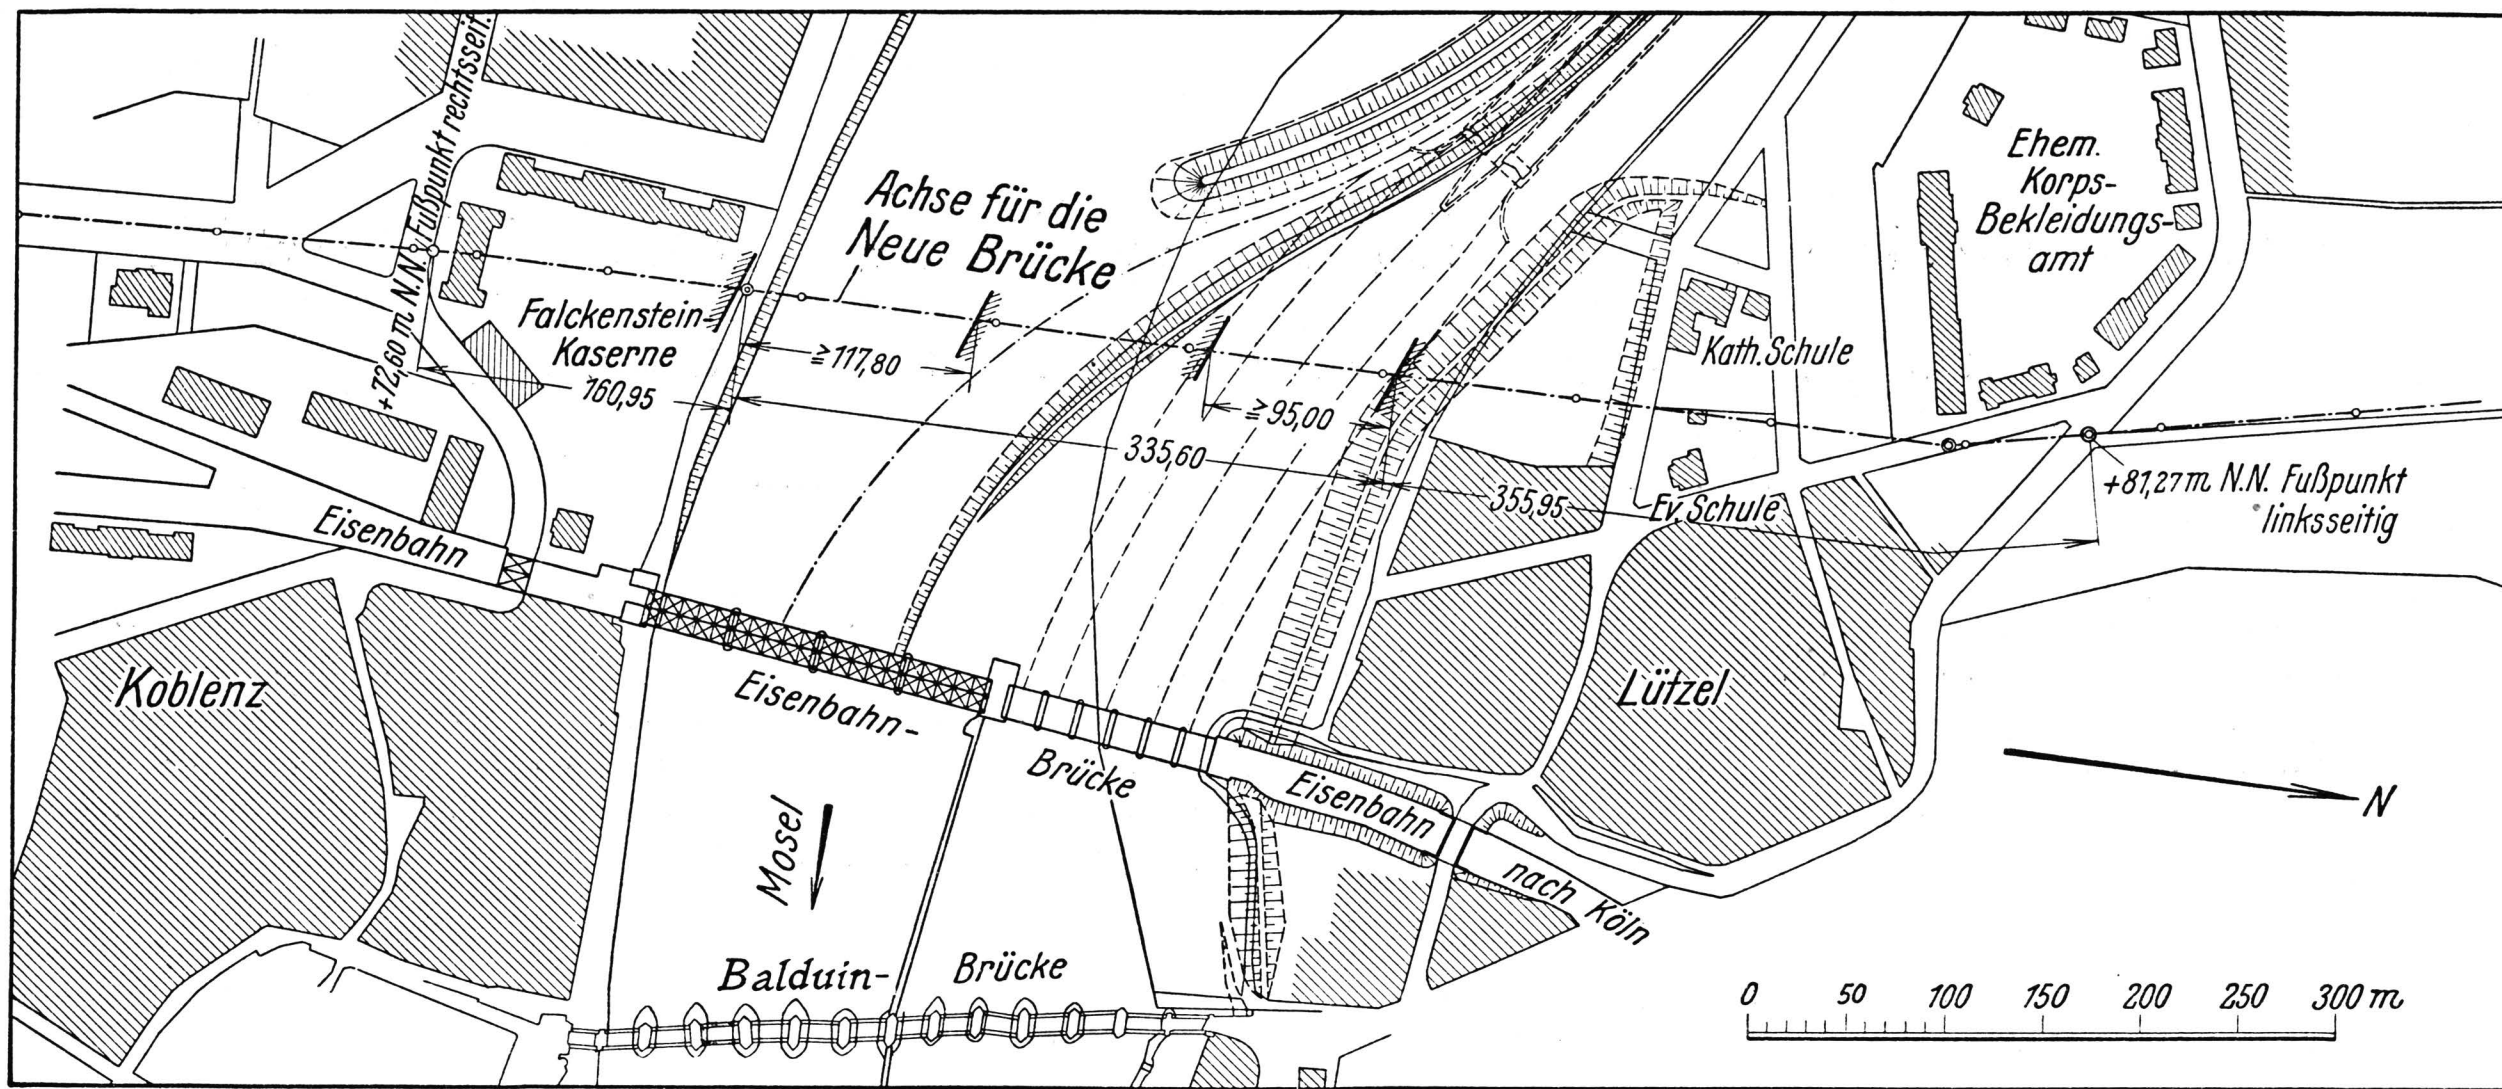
Lageplan der Adolf-Hitler-Brücke.
